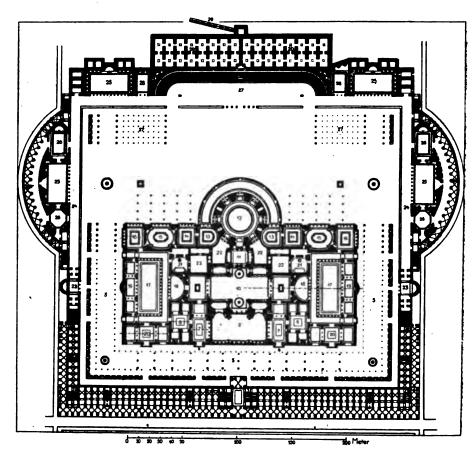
Grundrig ber hauptgebaube ber Thermen ber Caracalla gu Rom.
